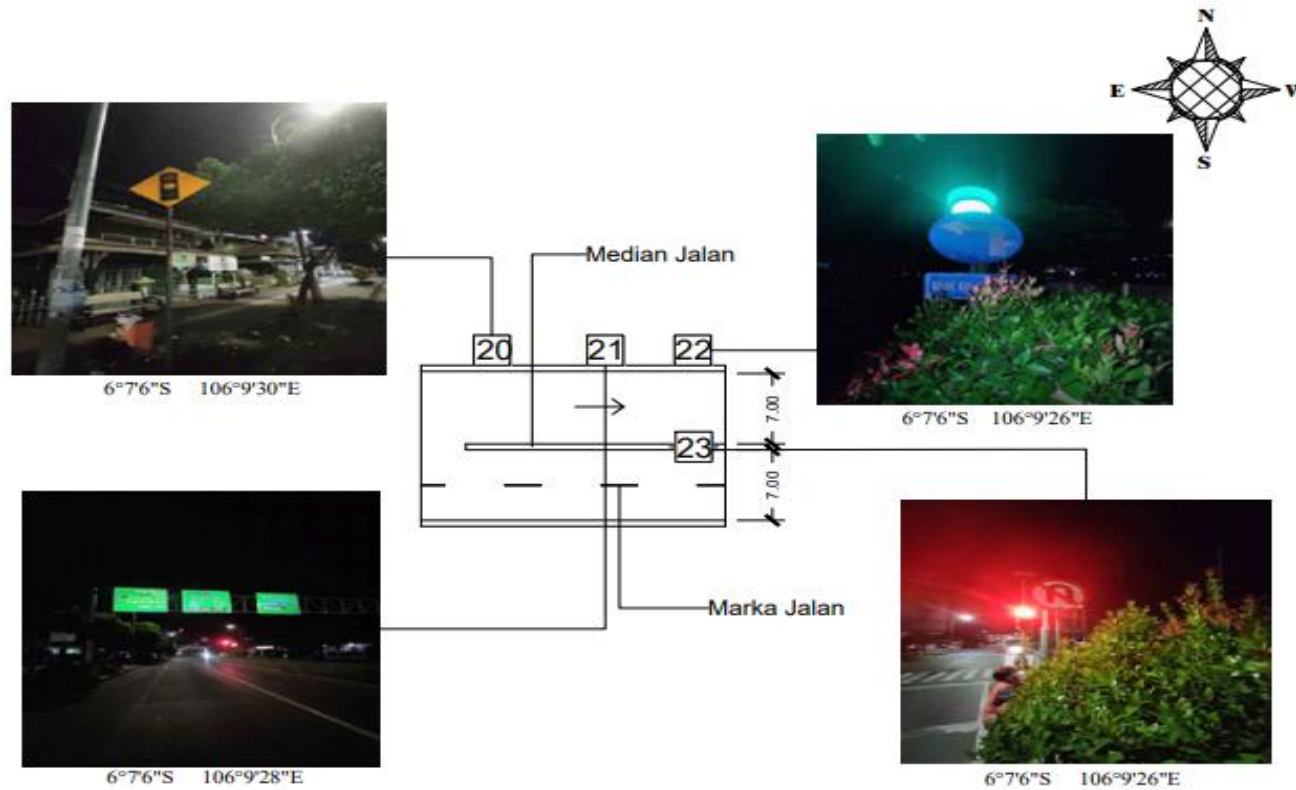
Potongan Site Plan Titik Lokasi Rambu
